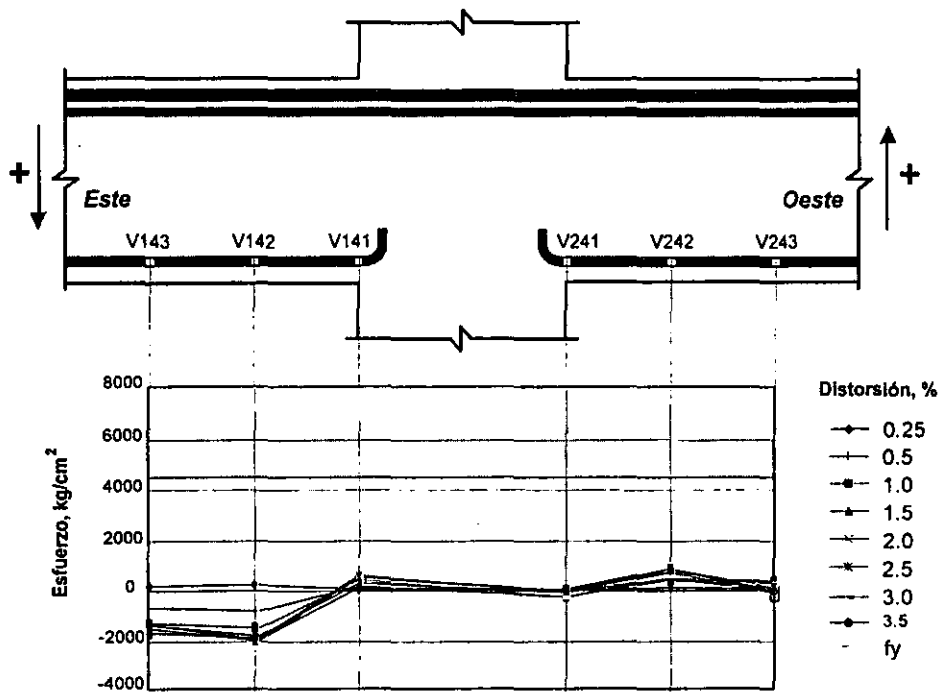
Esfuerzos en el acero de refuerzo del lecho inferior, E-O
